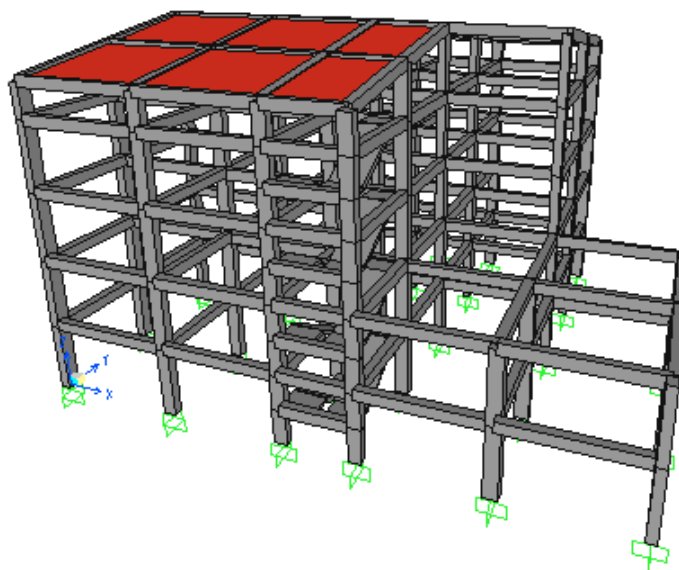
Modello 3D dell'edificio irregolare in pianta ed in elevazione
